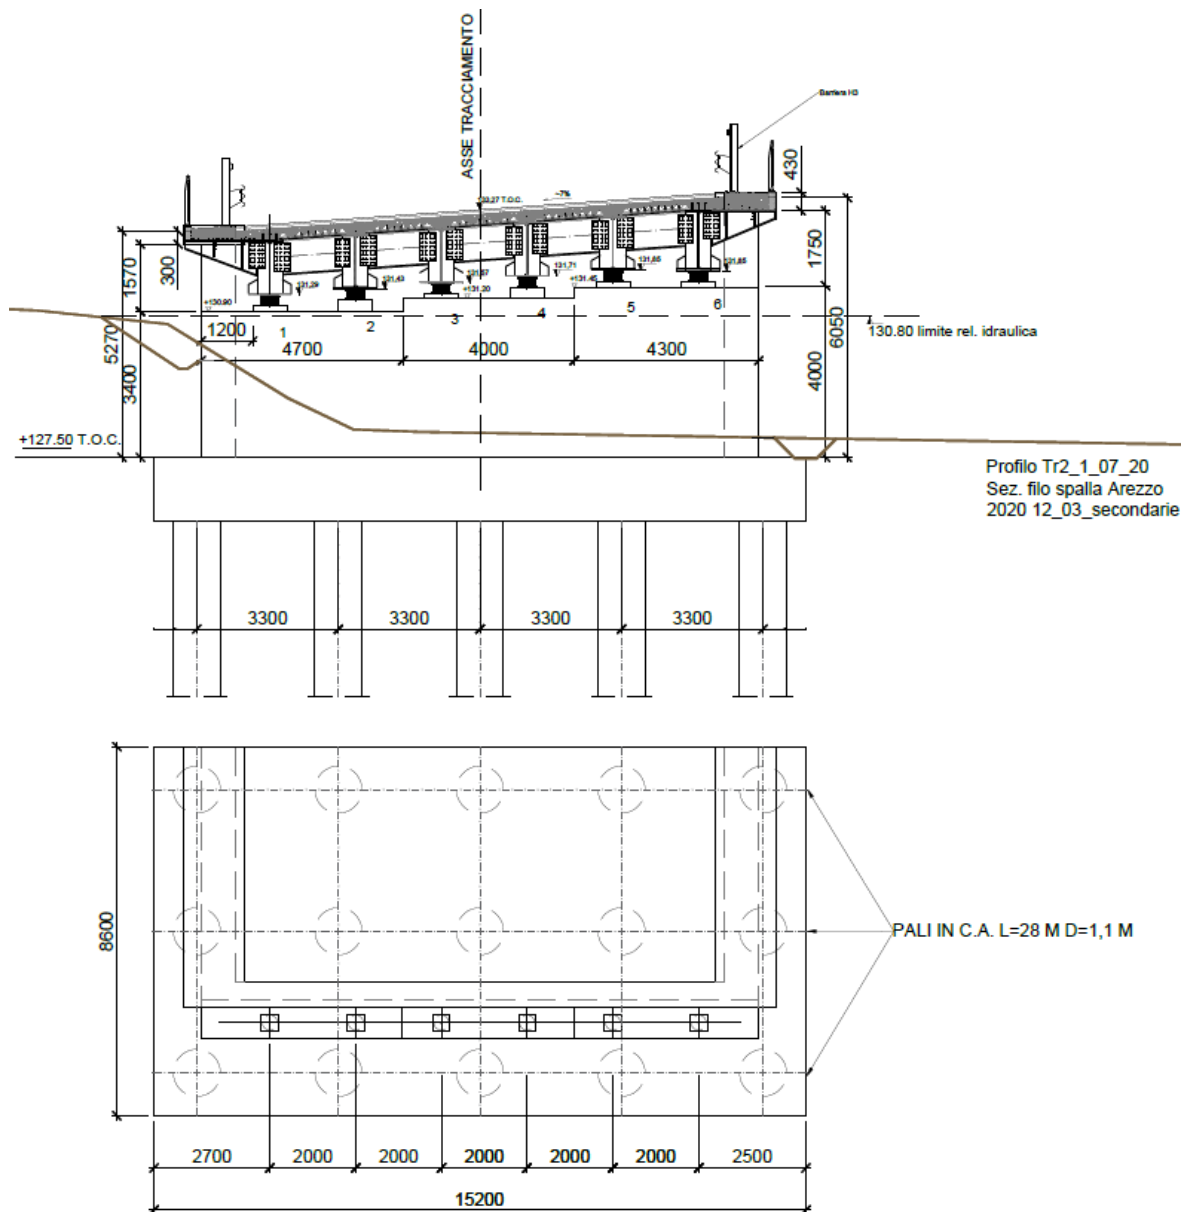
Sezione filo spalla Arezzo: vista di insieme.
